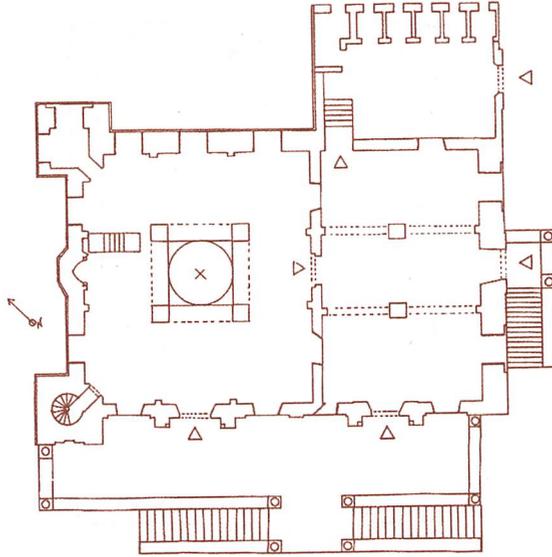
المسقط الأفقى لمسجد على باشا مهنا بمنشأة مهنا
